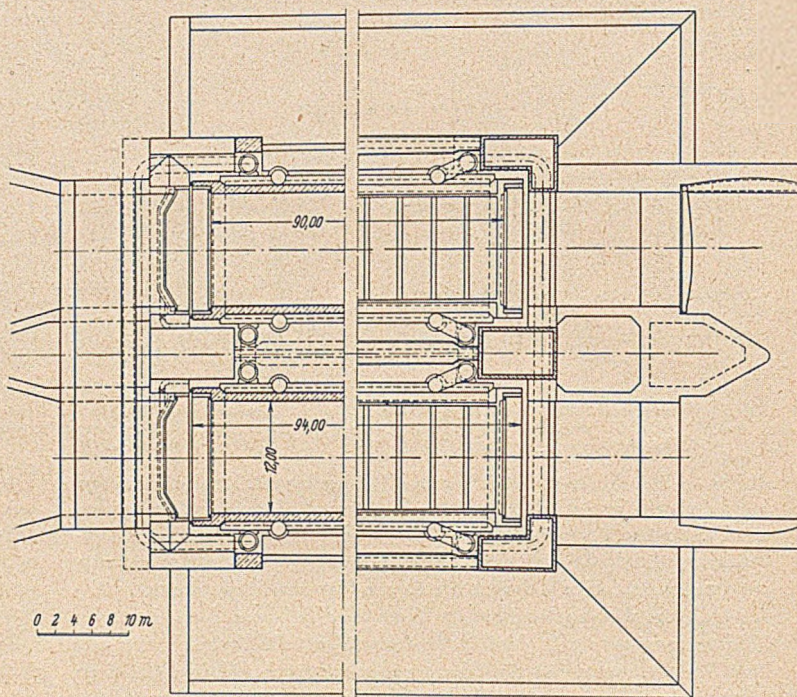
Grundriß der Tauchschleuse mit oben offenen Trögen.
